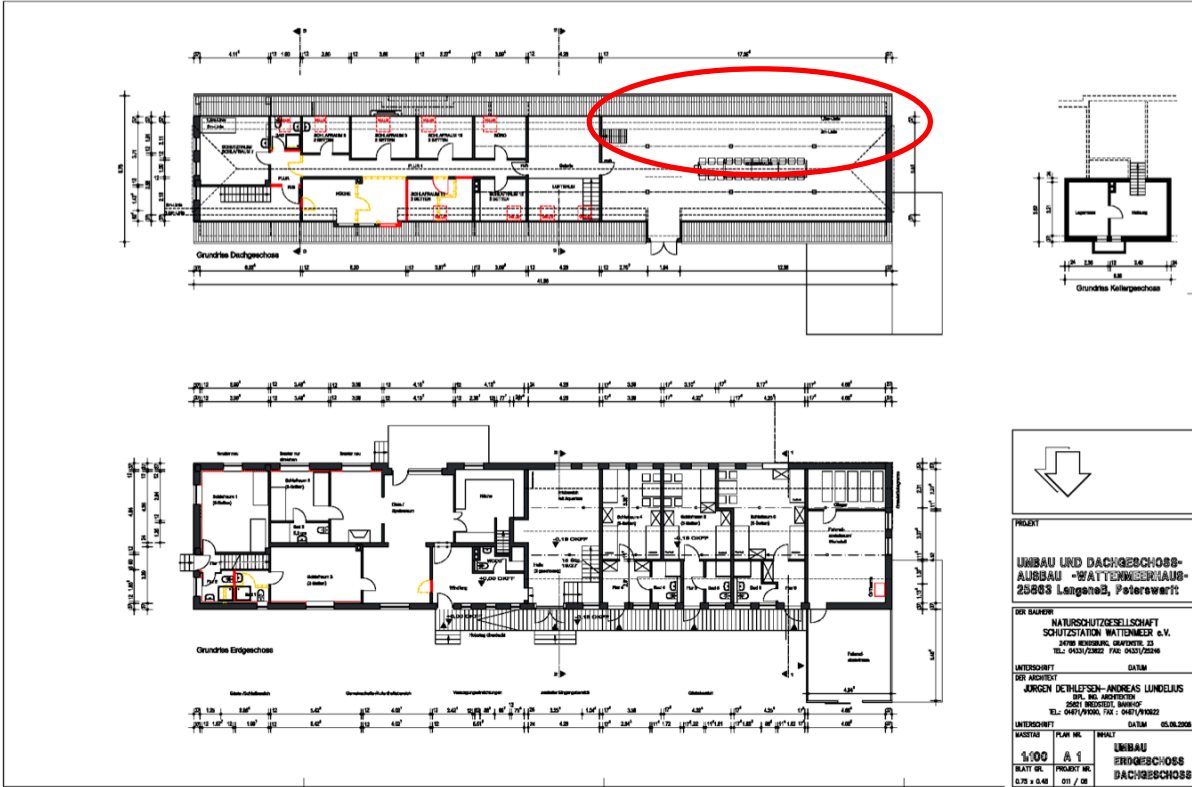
Projekt- und Umbauskizze: Grundriss des Nationalpark-Seminarhauses auf Langeneß (Dach- und Erdgeschoss). Der angestrebte Seminar- und Vortragsraum ist rot eingekreist.
